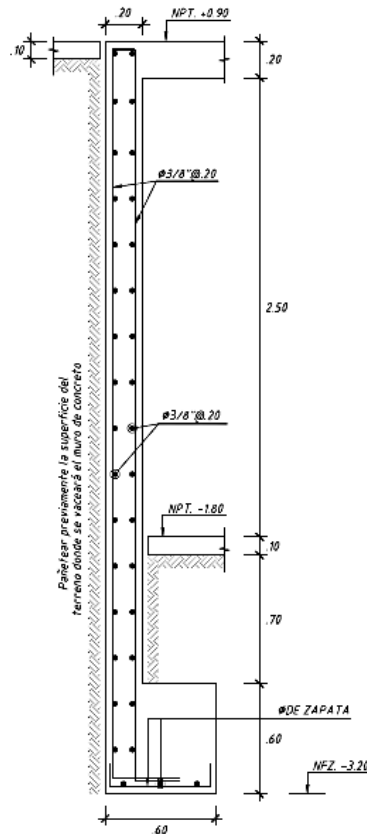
Esquema del armado final para el muro de sótano del ejemplo.
